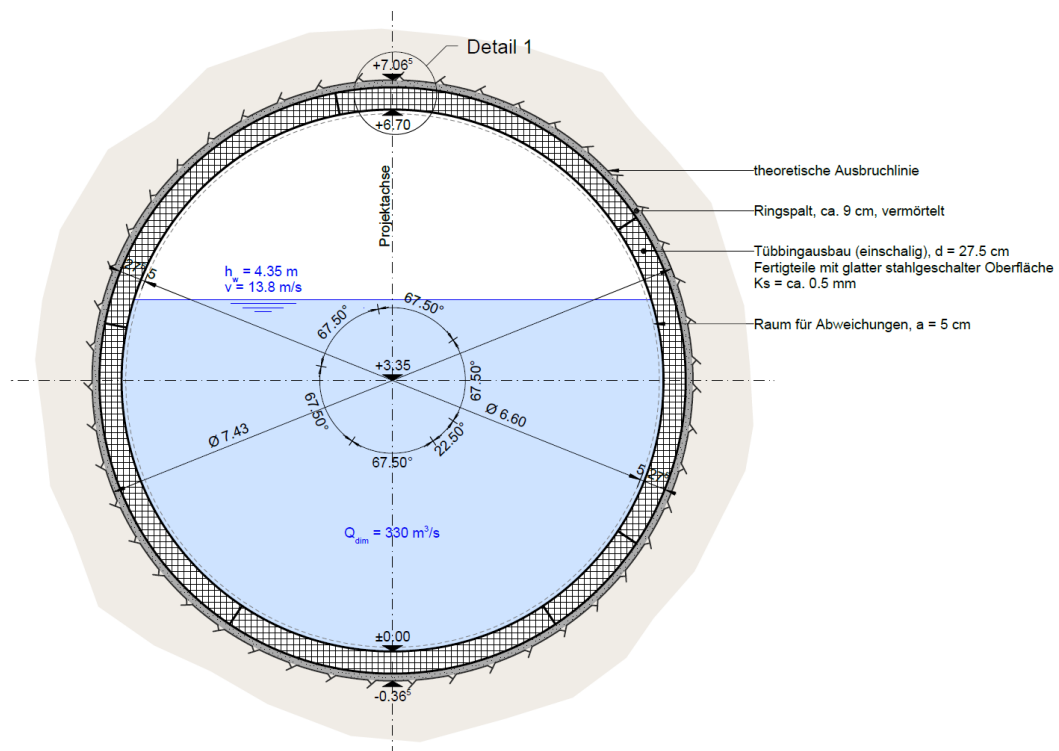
Normalprofil des Stollens mit Tübbingausbau (Plan 33-201)
